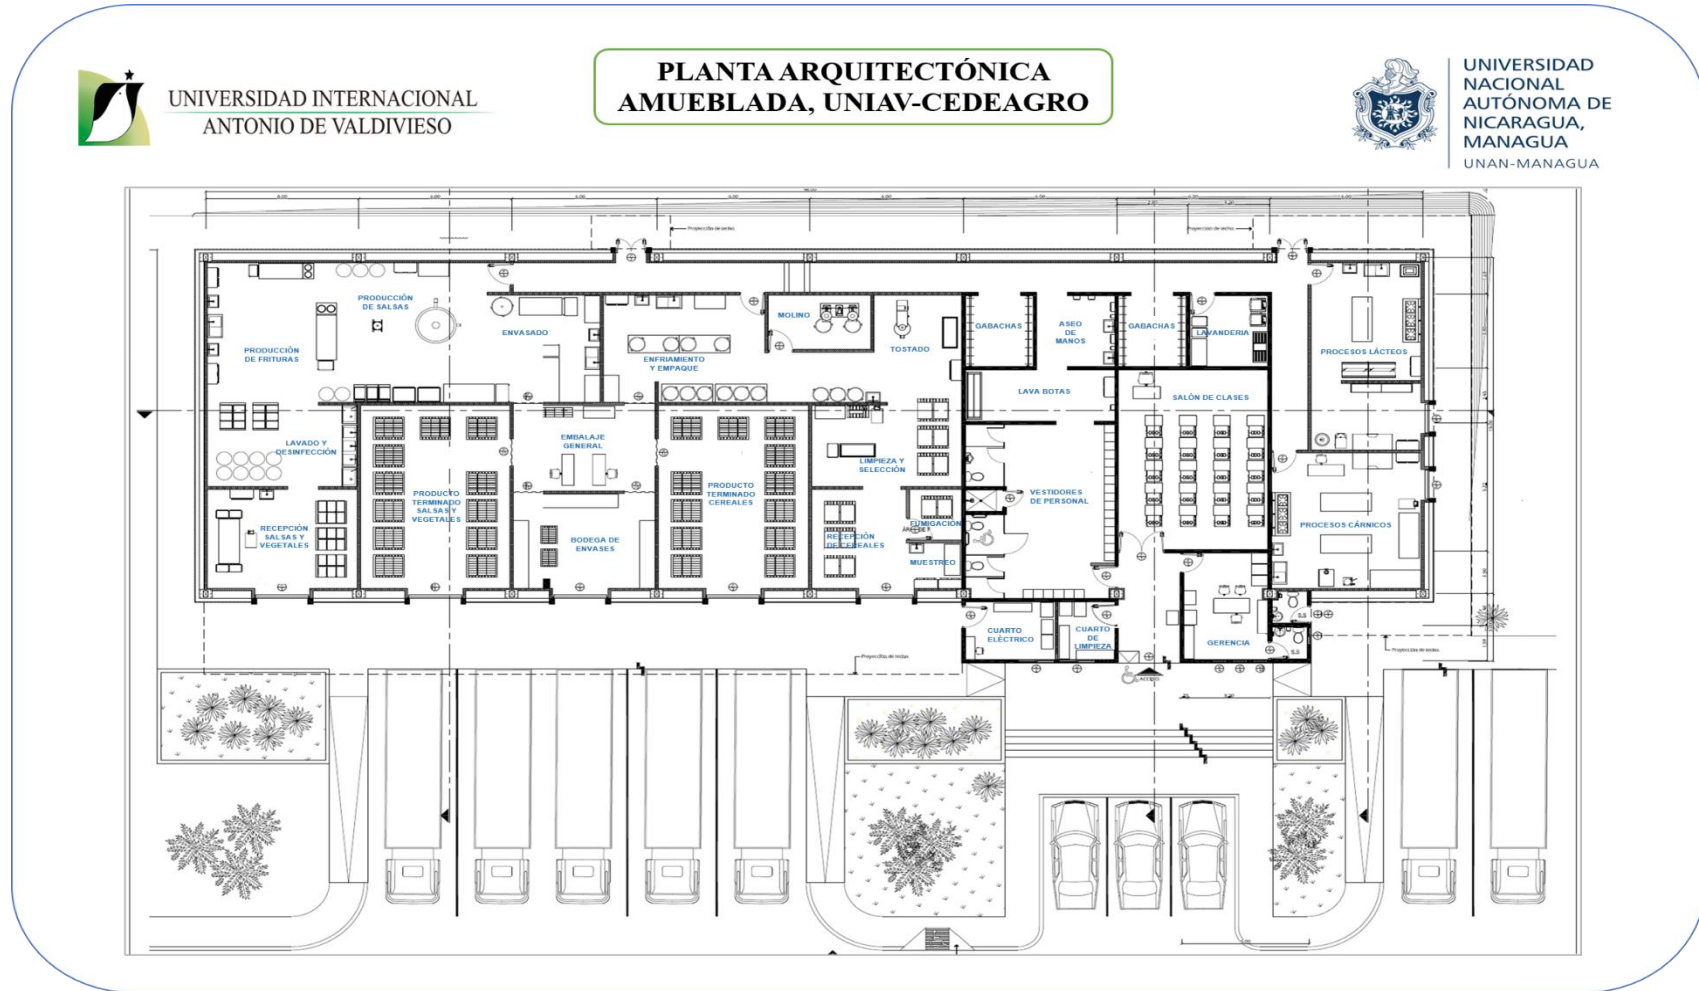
Planta Arquitectónica Amueblada, UNIAV-CEDEAGRO.
